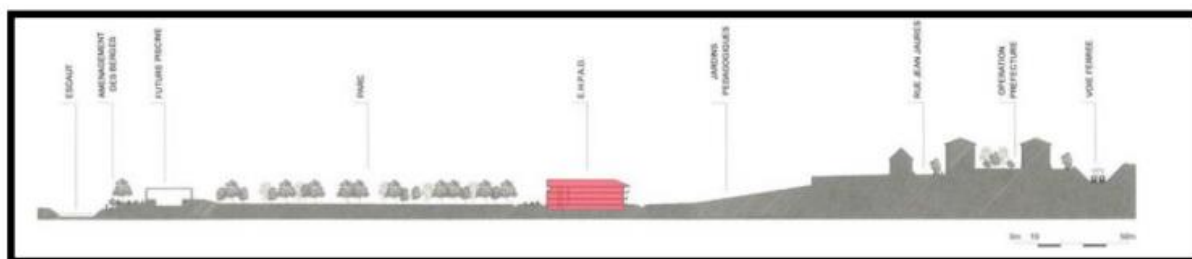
COUPE LONGITUDINALE SUR SITE
